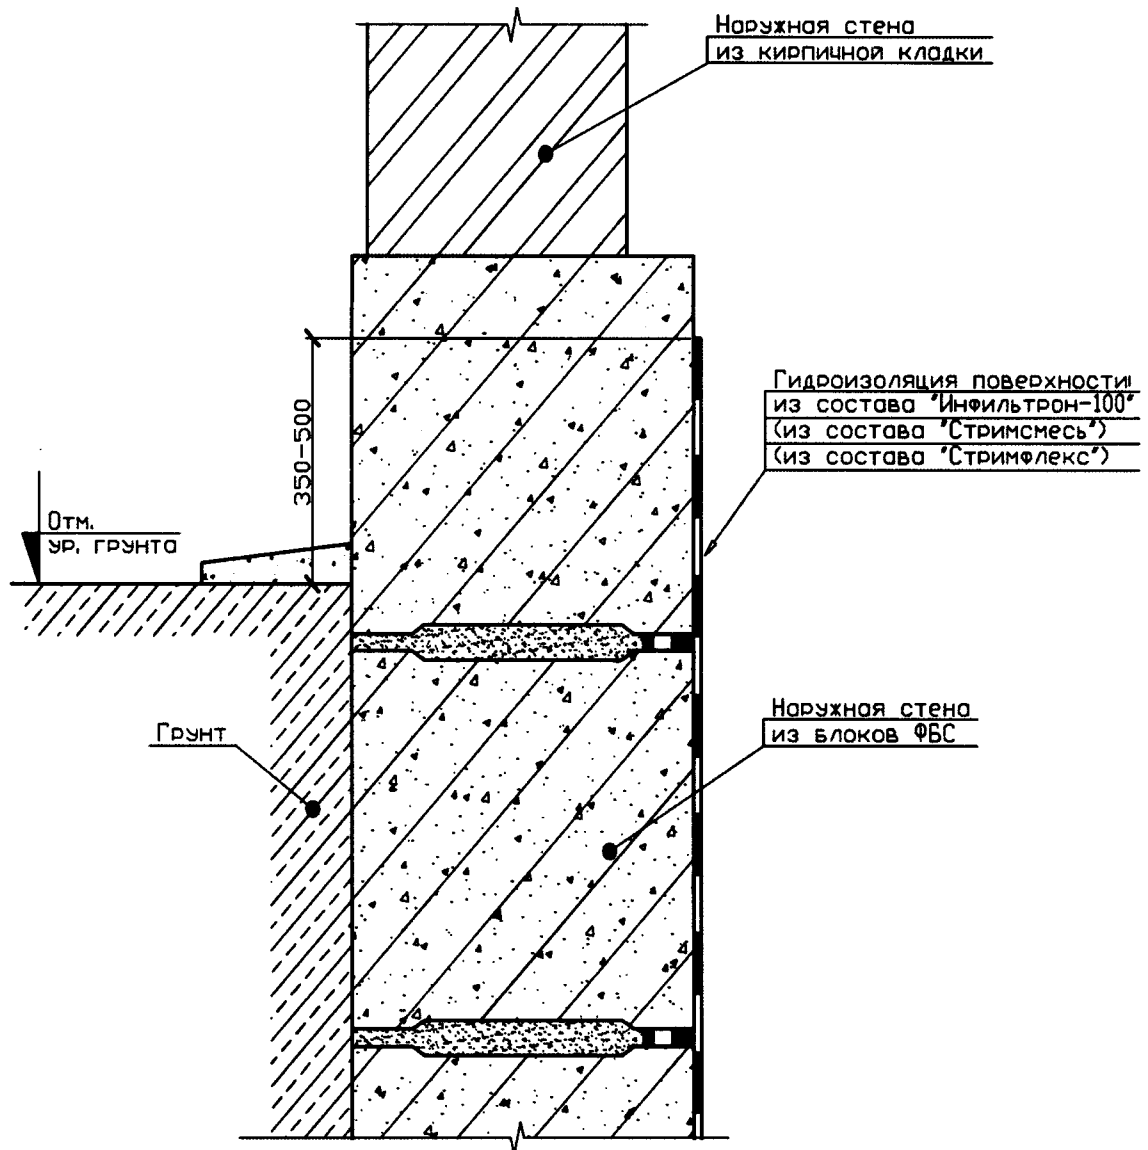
Гидроизоляция поверхностей сборных железобетонных конструкций. Гидроизоляция поверхностей наружных стен из блоков ФБС в зоне отметки уровня грунта
